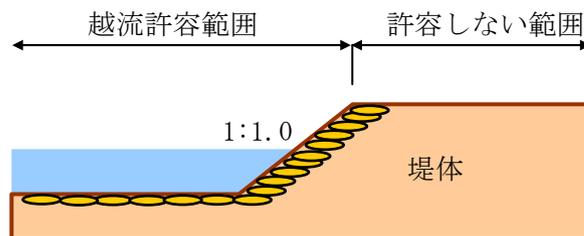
越流許容範囲と許容しない範囲の取付構造
